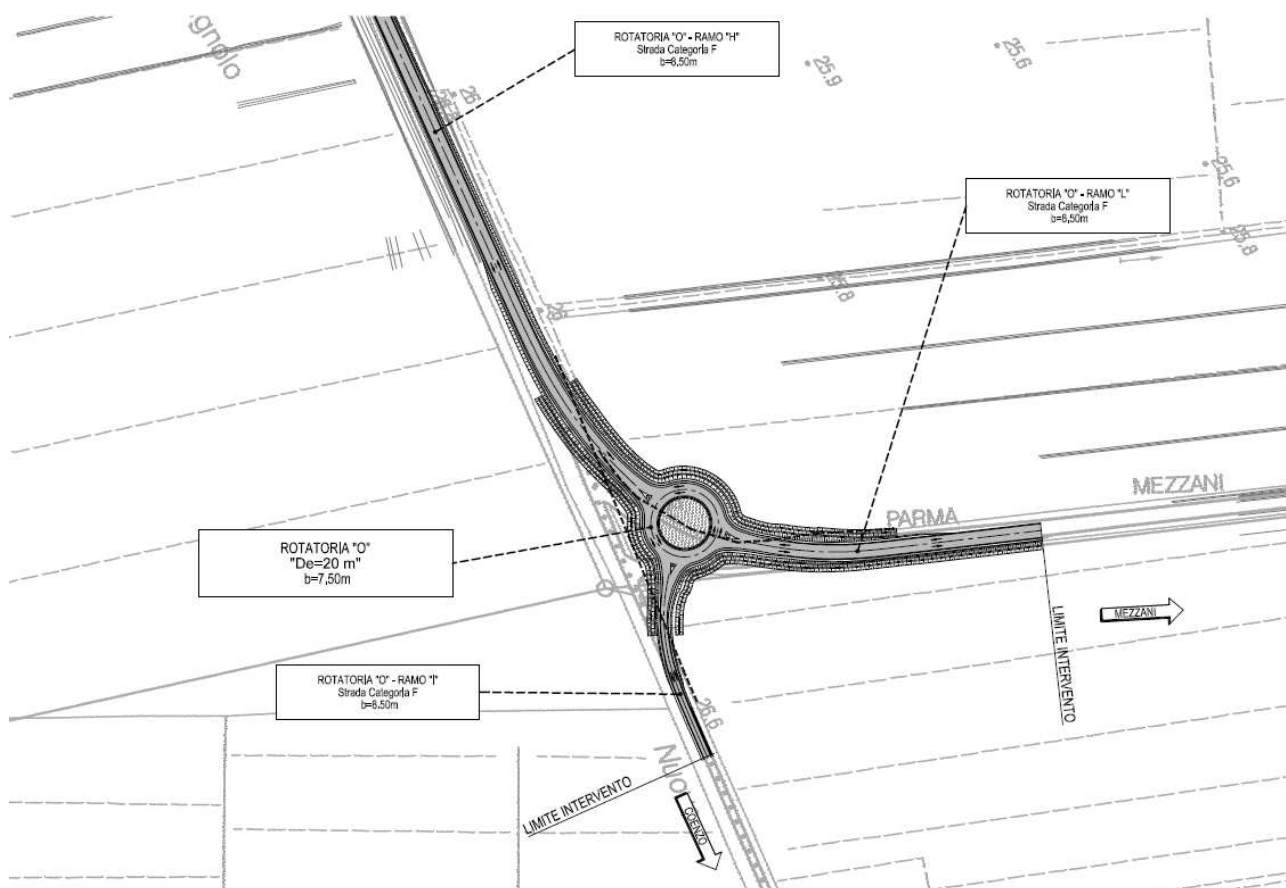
PLANIMETRIA DI PROGETTO – TRATTO 3 - OPERA D01 (EX 1PR)
